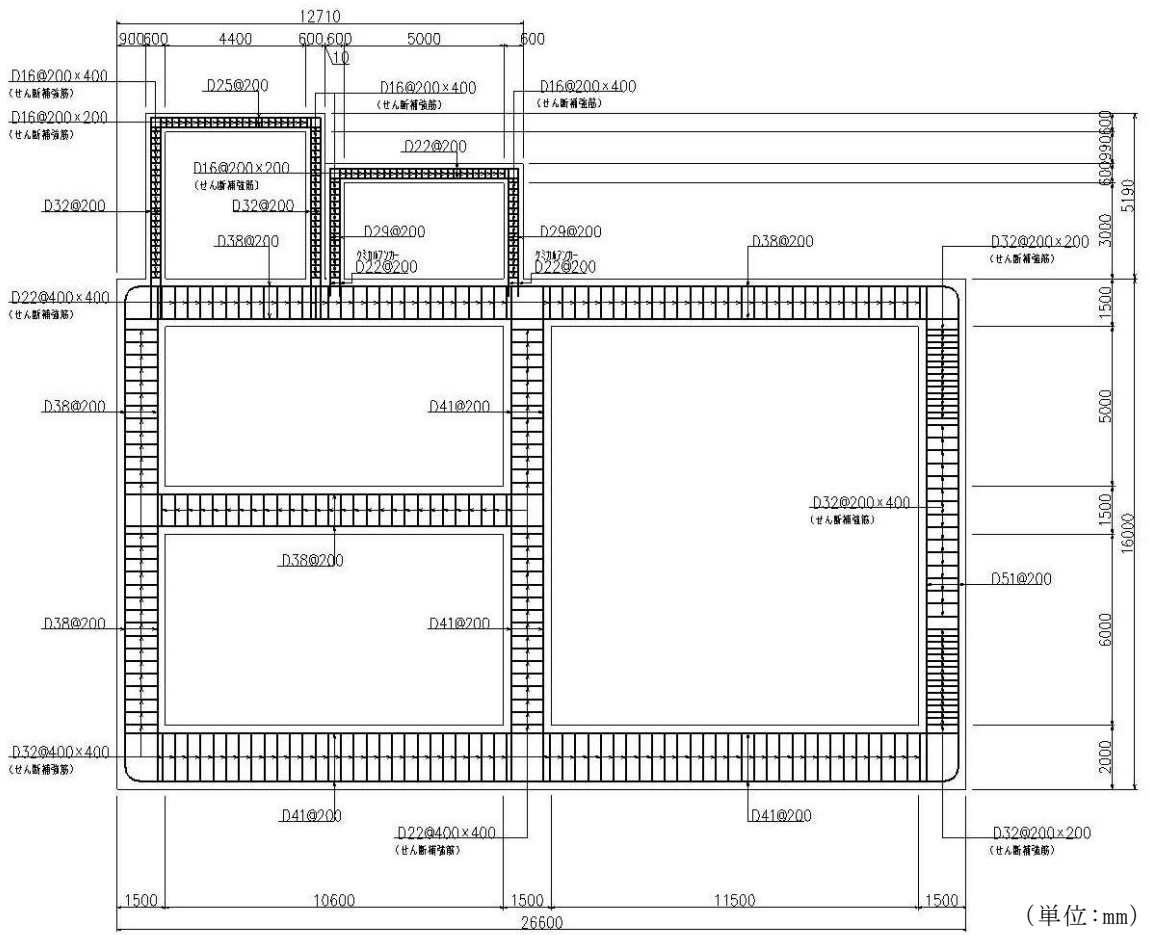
低圧原子炉代替注水ポンプ格納槽 概略配筋図 (C-C 断面)
